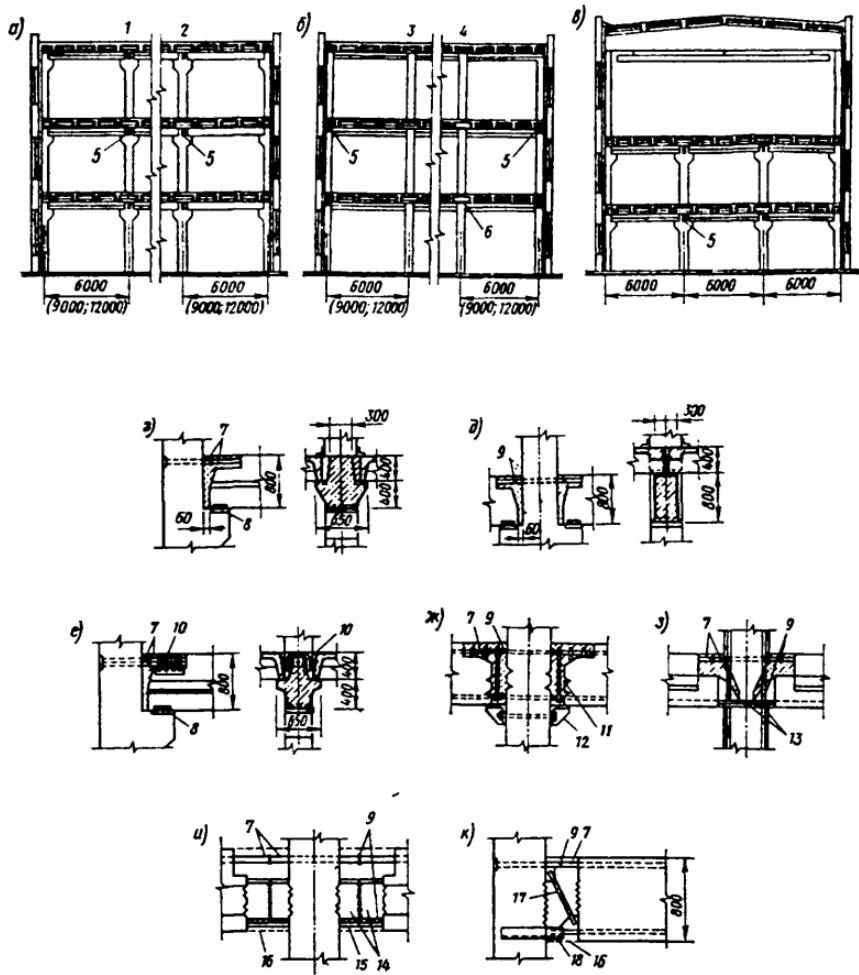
Многоэтажные здания со сборным железобетонным каркасом (разрезы и детали):
